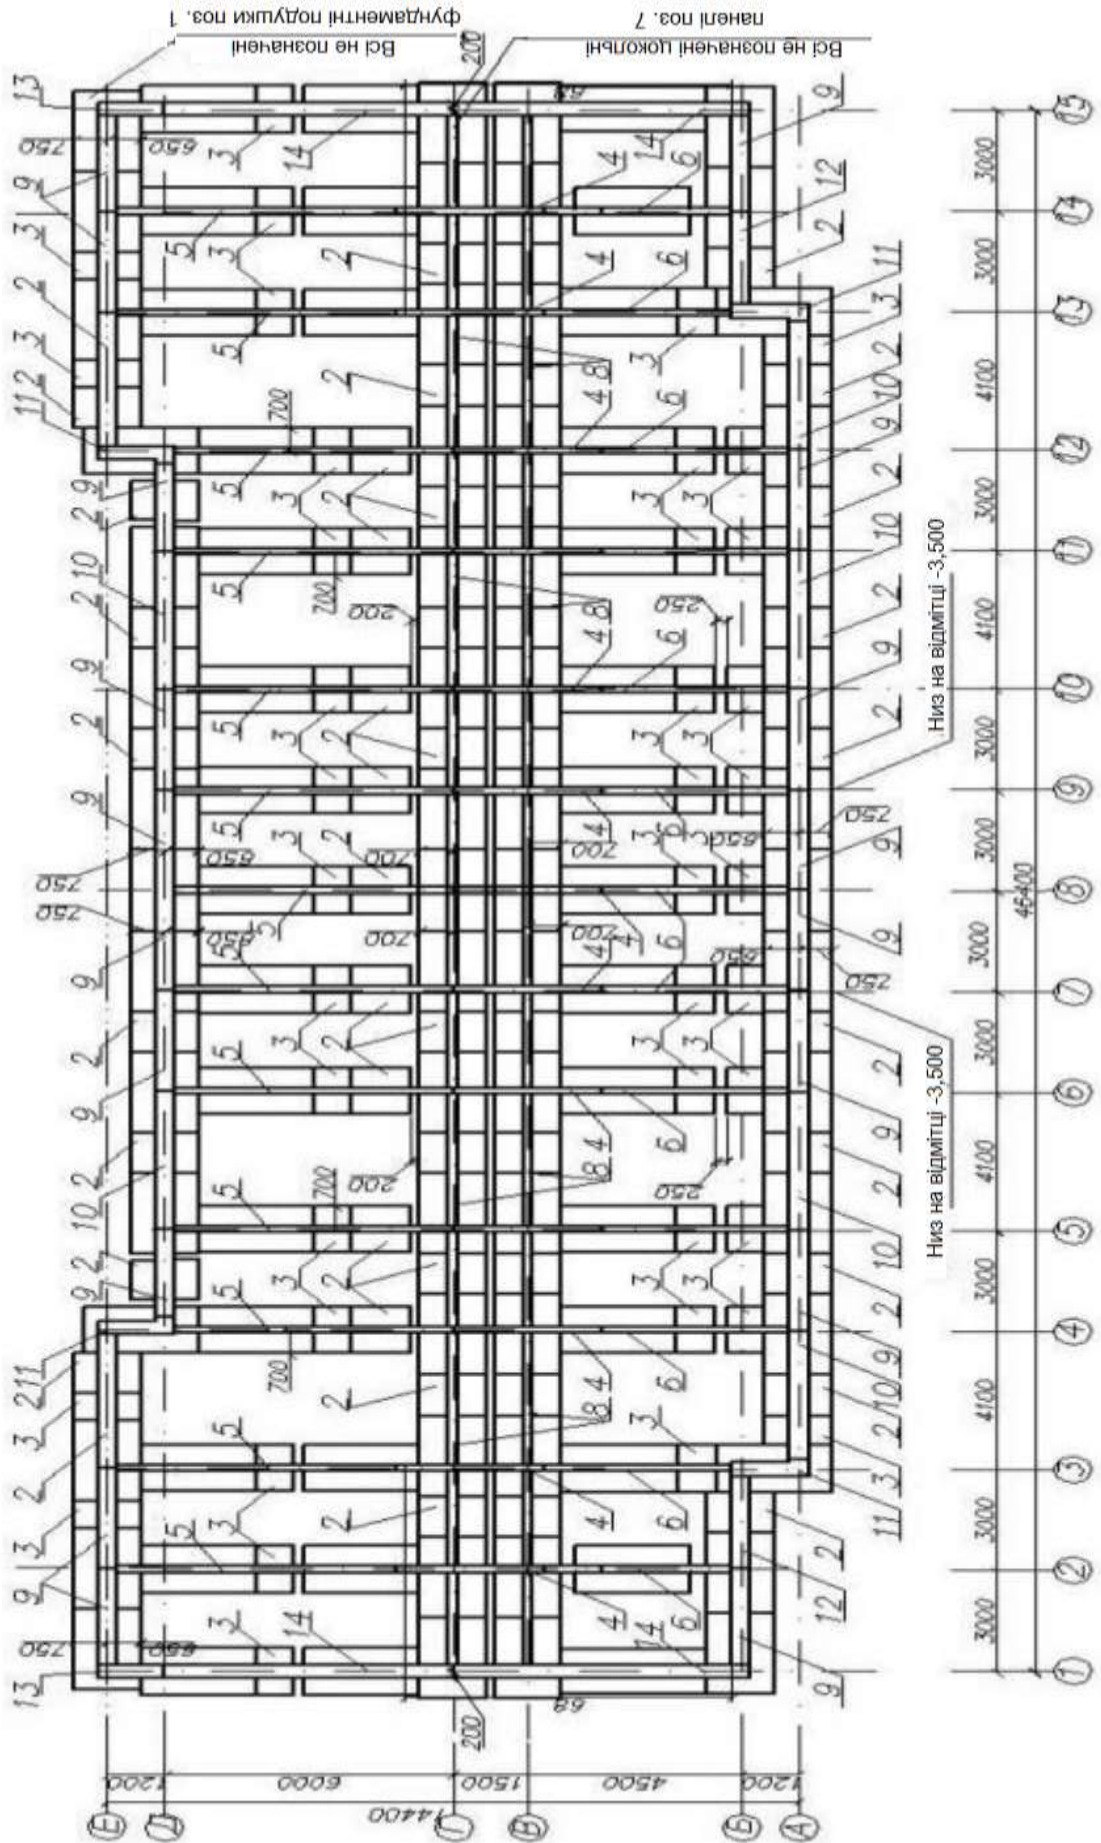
План збірних залізобетонних стрічкових фундаментів крупнопанельних будівель
